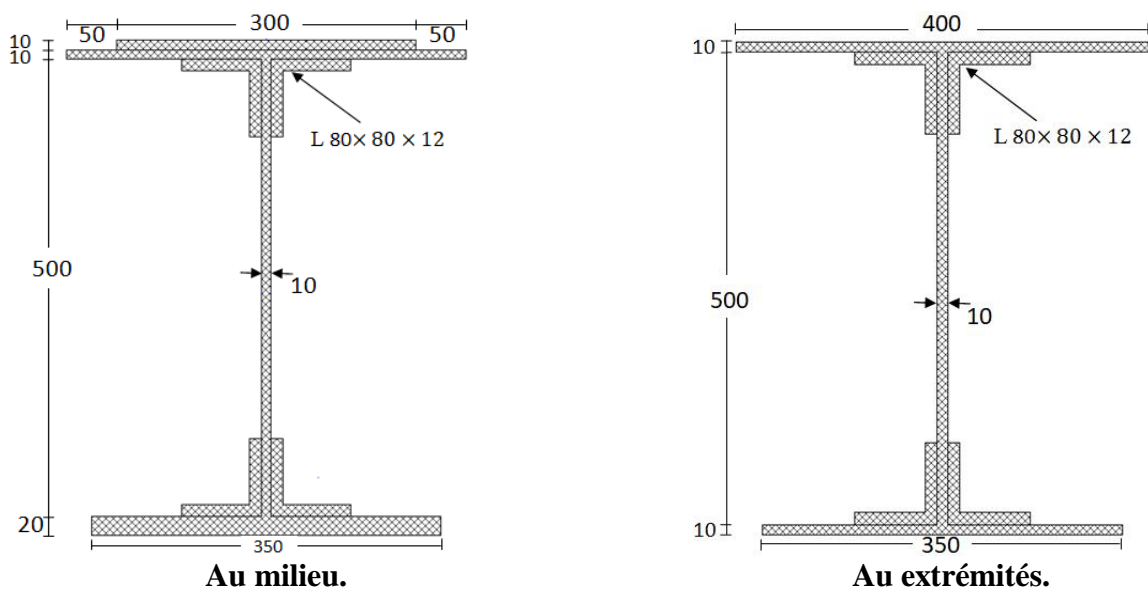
Détails géométrique de la Poutrelle biaisée.
